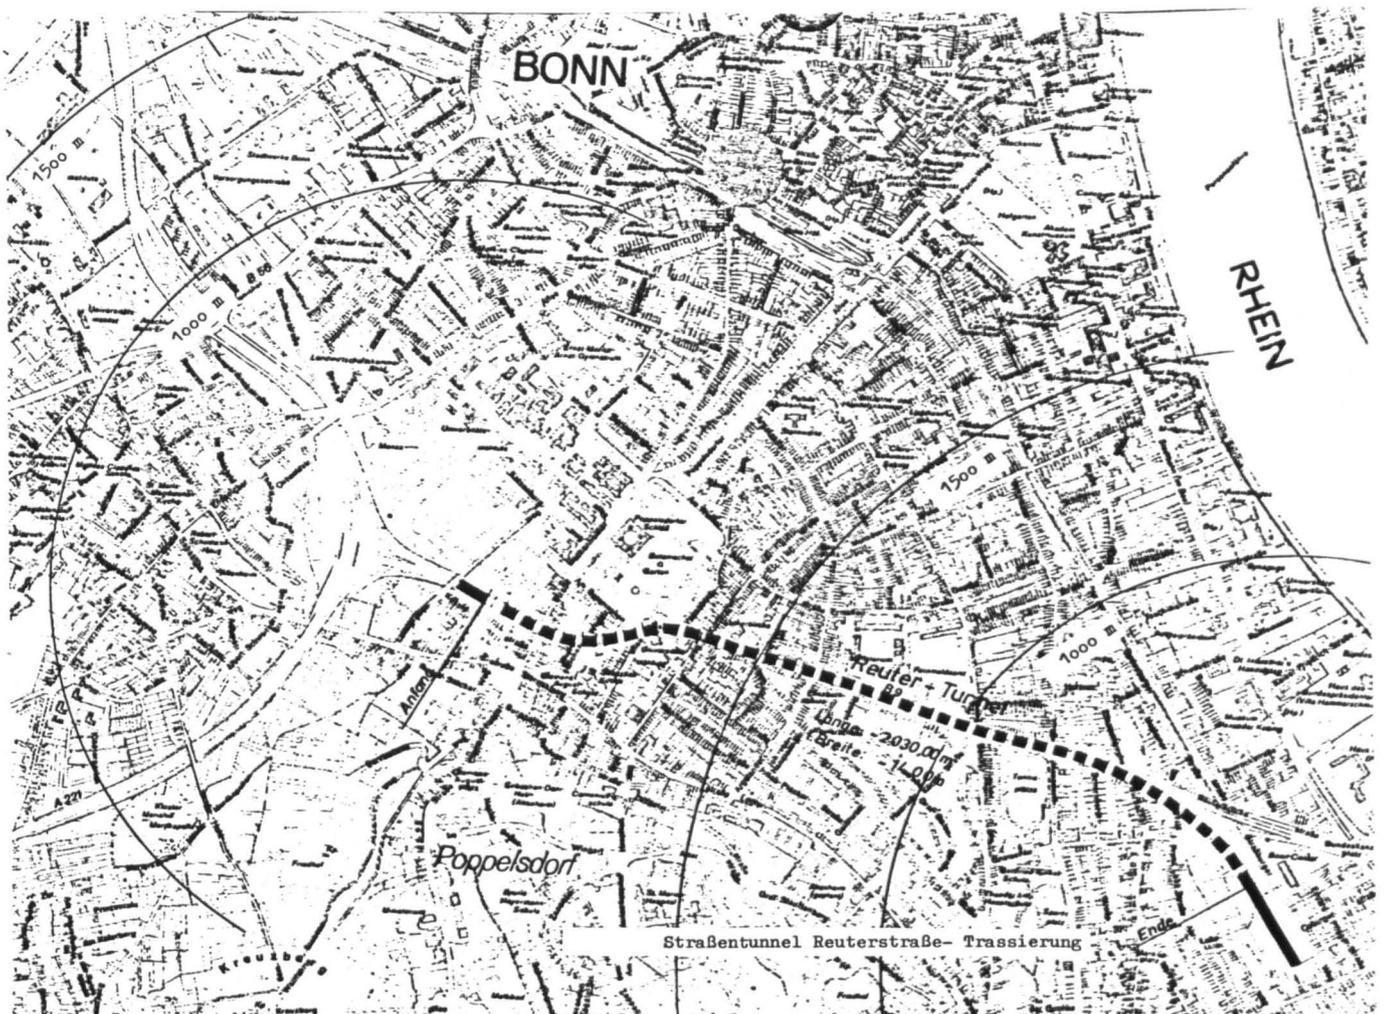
Straßentunnel Reuterstraße – Trassierung.
